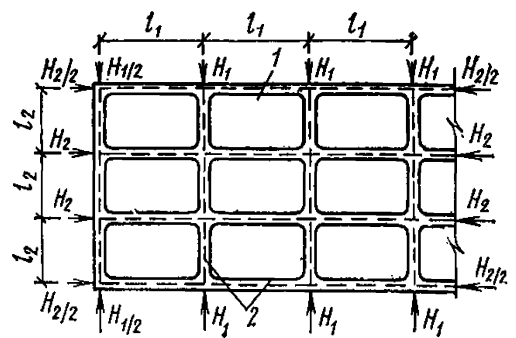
Схема неразрезного сборного перекрытия с предварительно-напряженной арматурой, уложенной в швы между панелями
